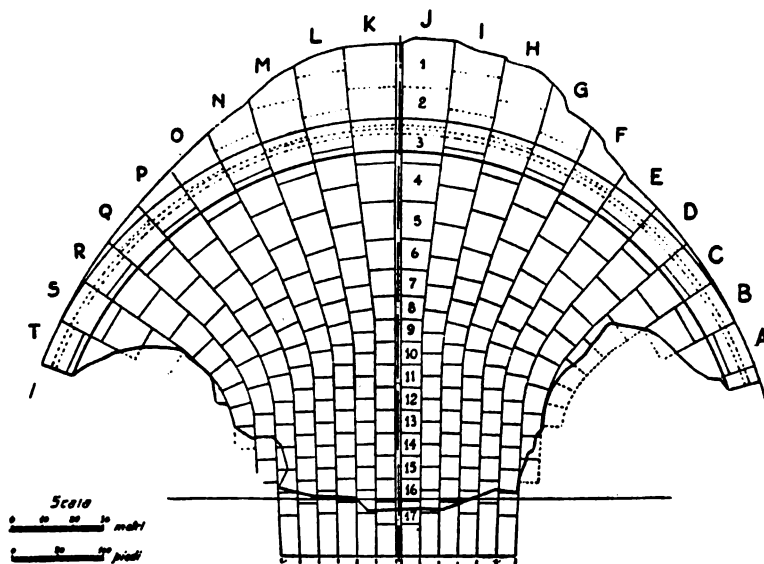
Planimetria della diga, con indicazione dei blocchi secondo i quali venne gettato il calcestruzzo.
